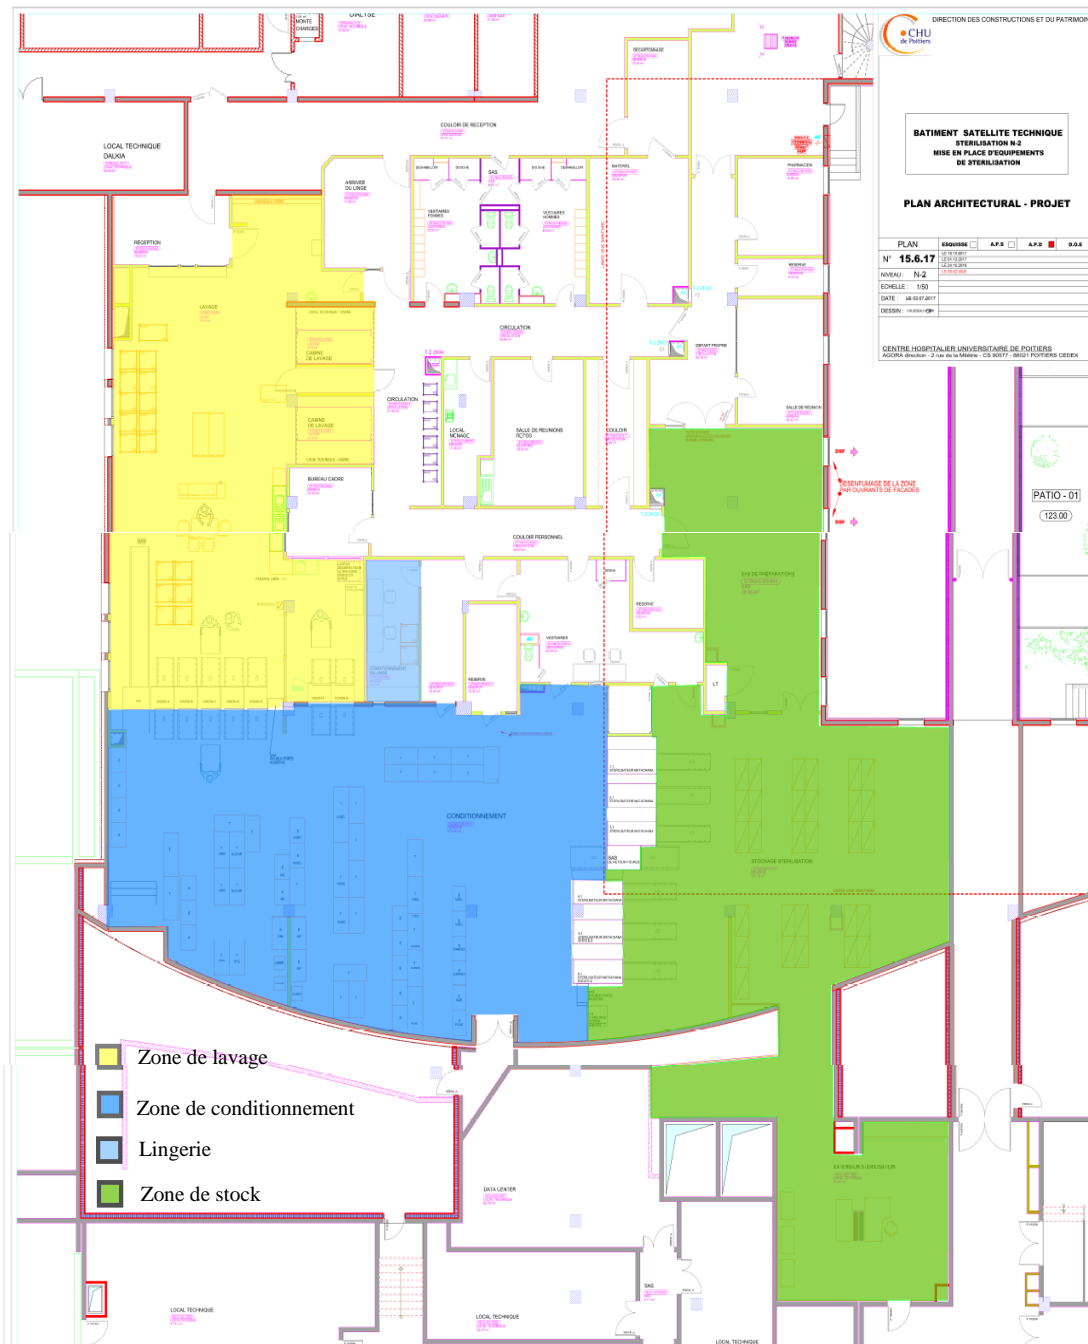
Plan de la Stérilisation Centrale du CHU de Poitiers
